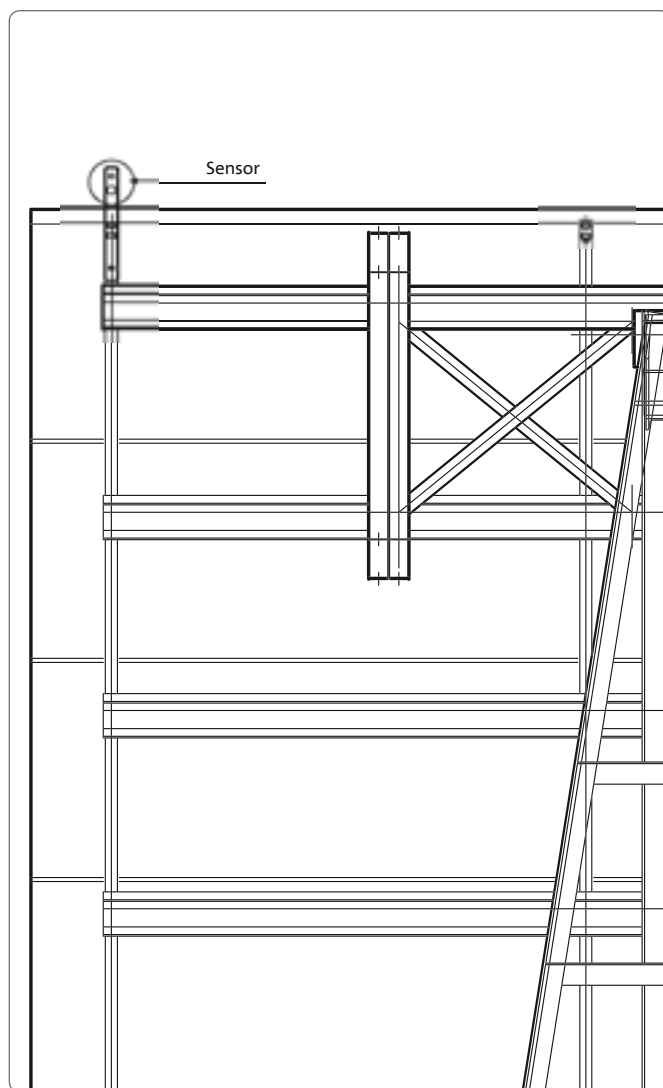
Montage des Sensors (Ansicht von hinten)
